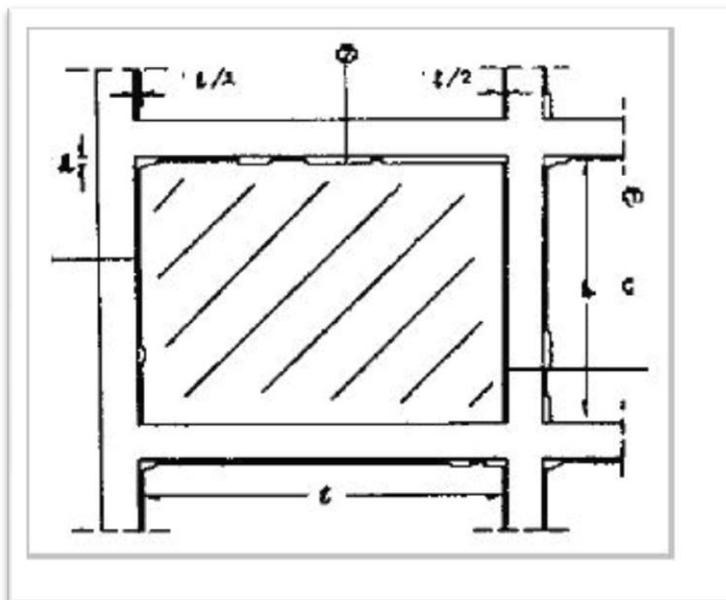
Fissuras Causadas pela dilatação térmica
